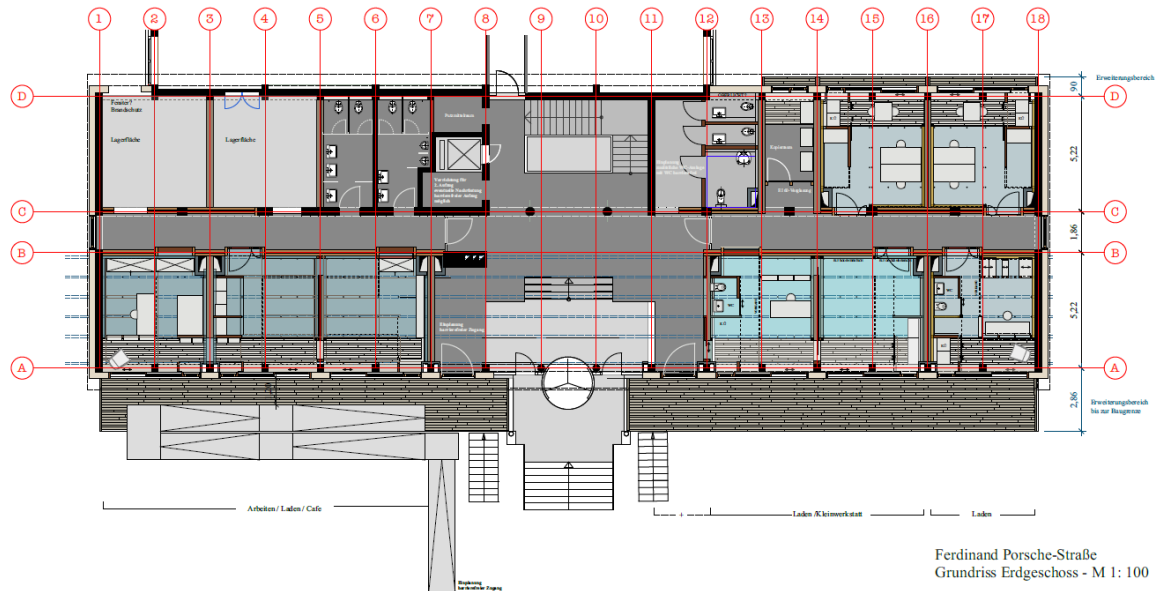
/ Neuplanung Grundriss Erdgeschoß
